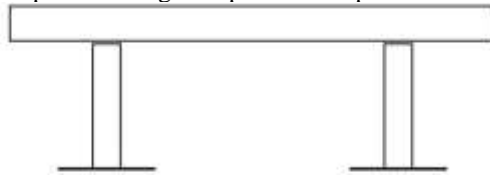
Ponte em vigas simplesmente apoiada com diversos vãos:
